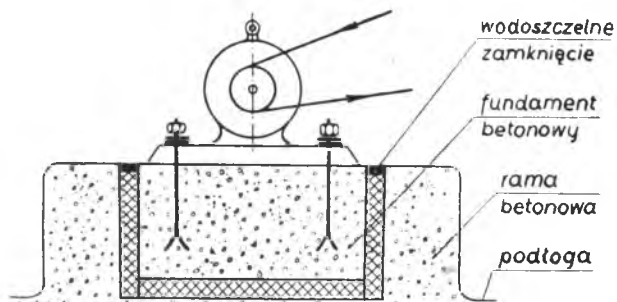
Fundament betonowy na podkładkach przeciwdźwiękowych.
